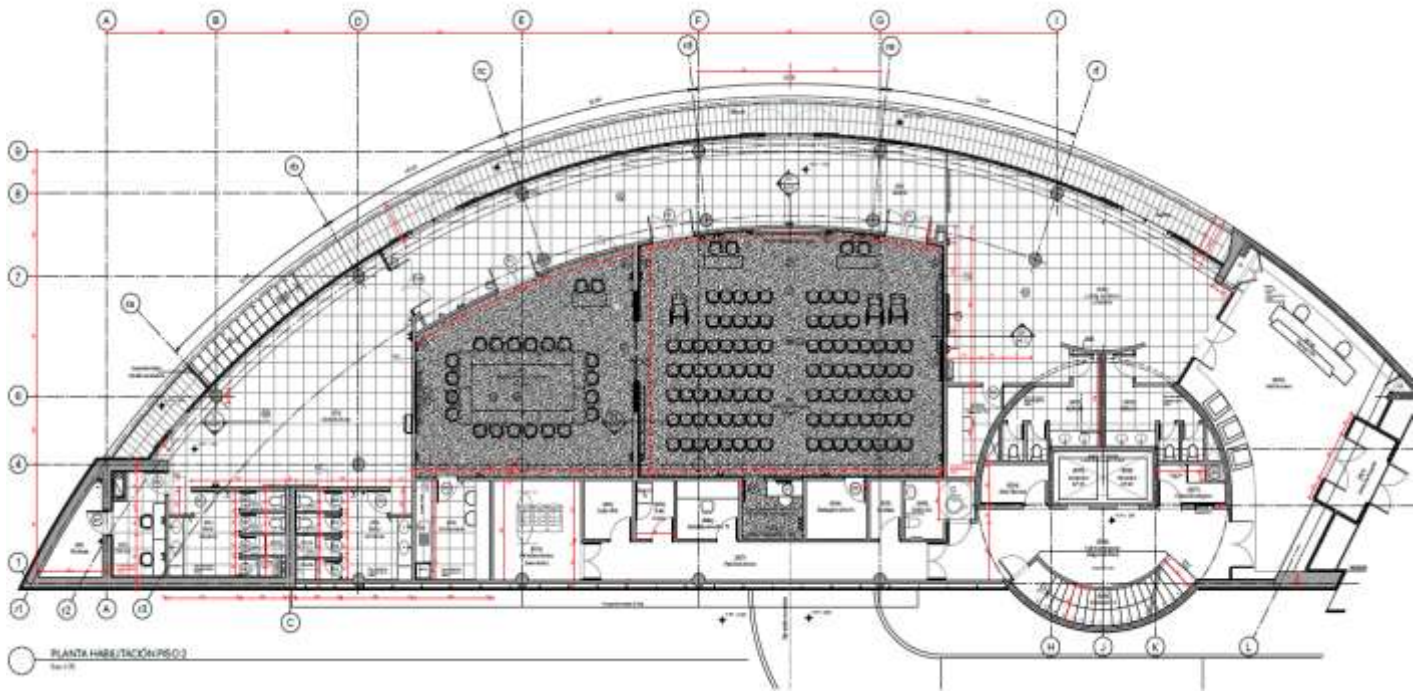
Planta Arquitectura referencial segundo piso edificio EPSA.
